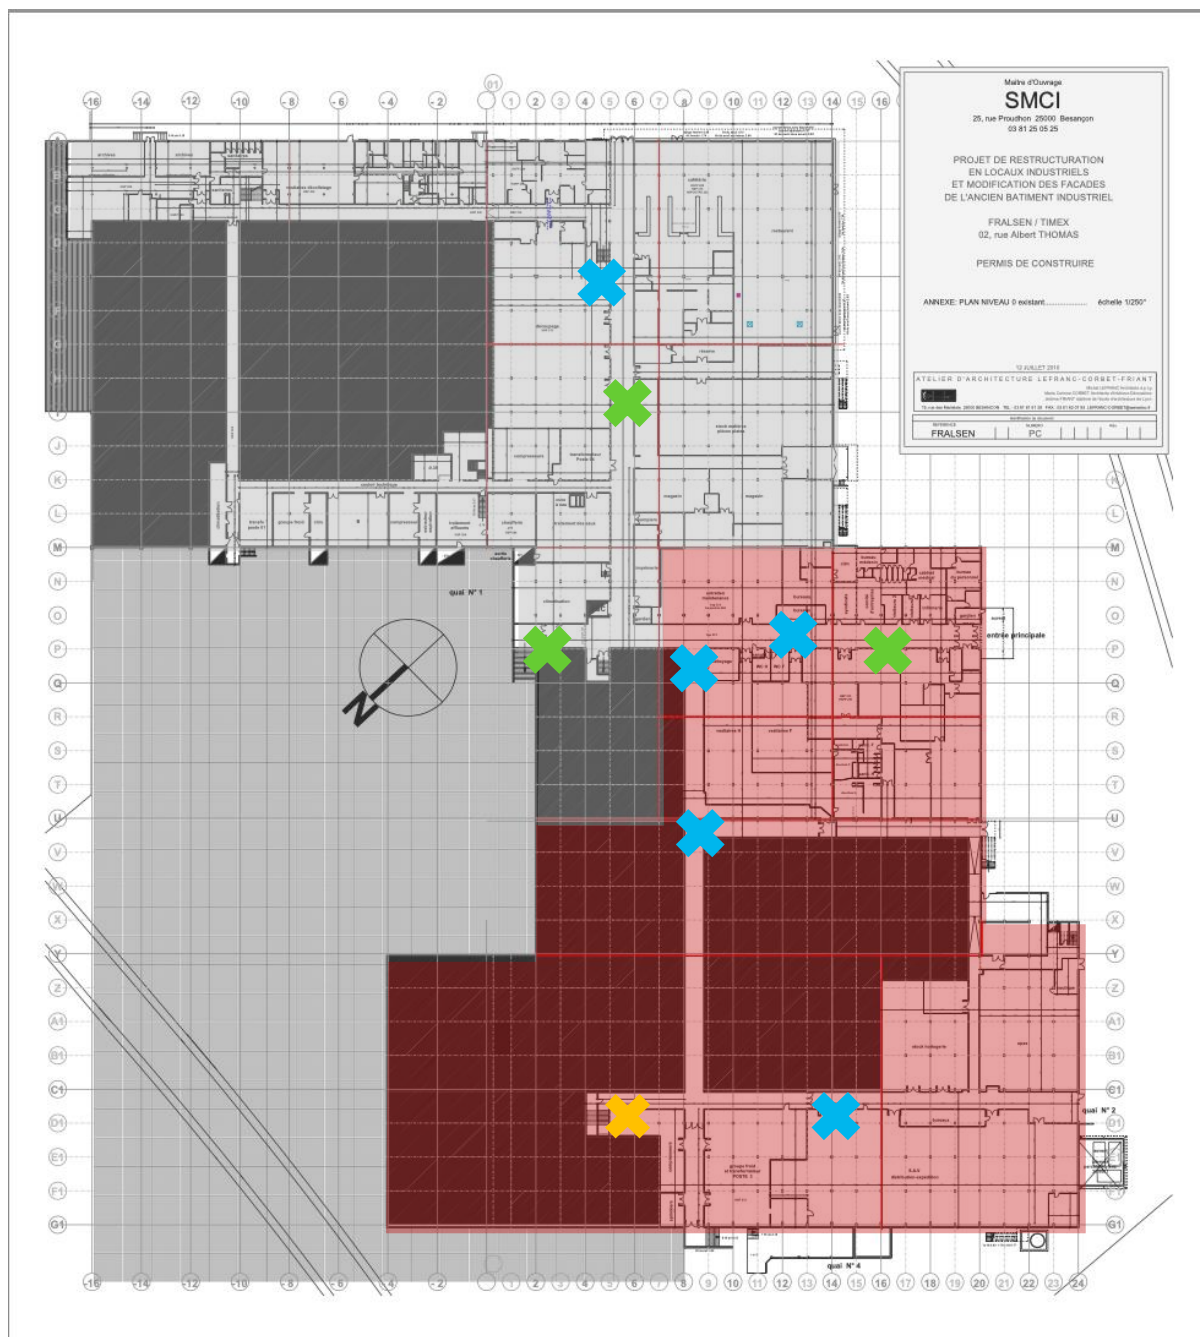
Plan du niveau 0 existant – Emplacement des prélèvements
